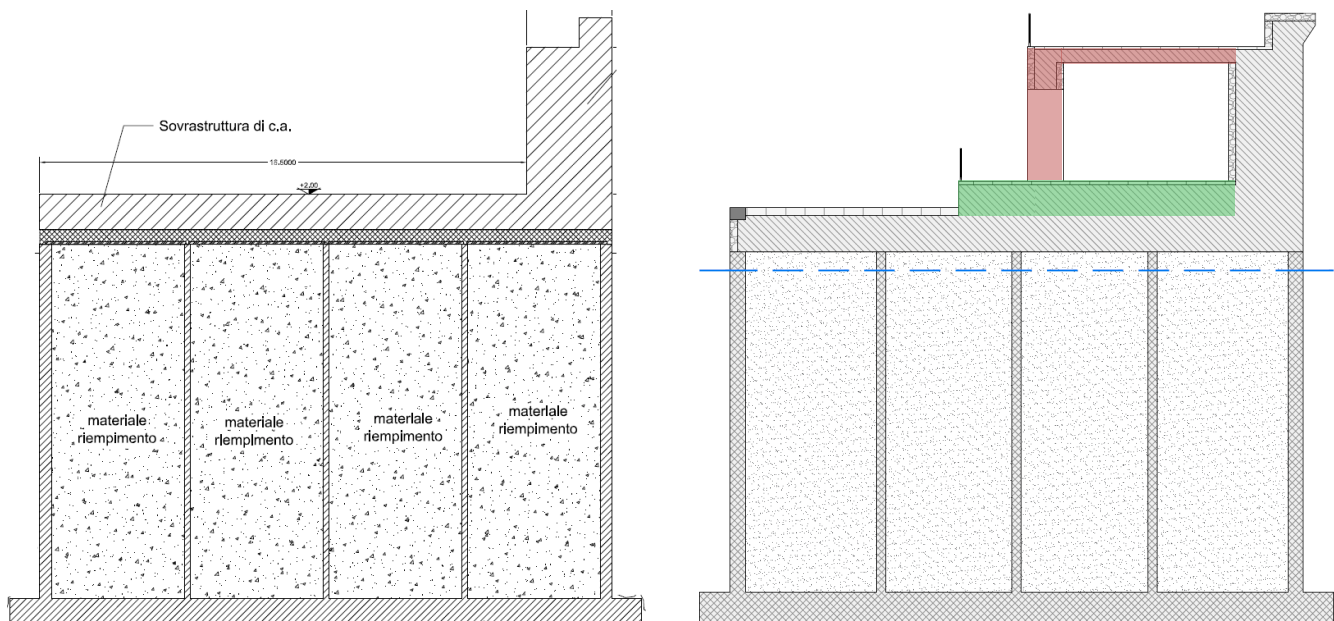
Confronto sezioni cassone: Progetto Preliminare (sx) e Progetto Definitivo (dx)
